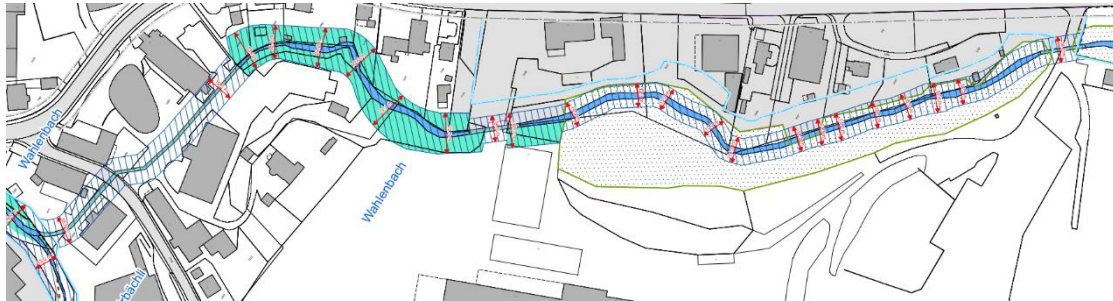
Planausschnitt Wahlenbach (Quelle: Mutationsplan, 1:1'000)
